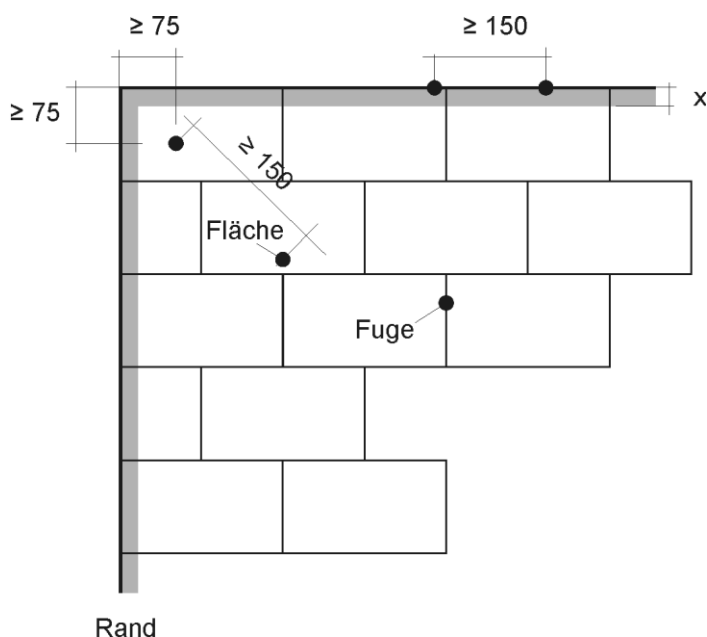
Beschussorte für den Putz im Grundriss (x : $1/5$ Projektildurchmesser, Masse in Millimeter)
